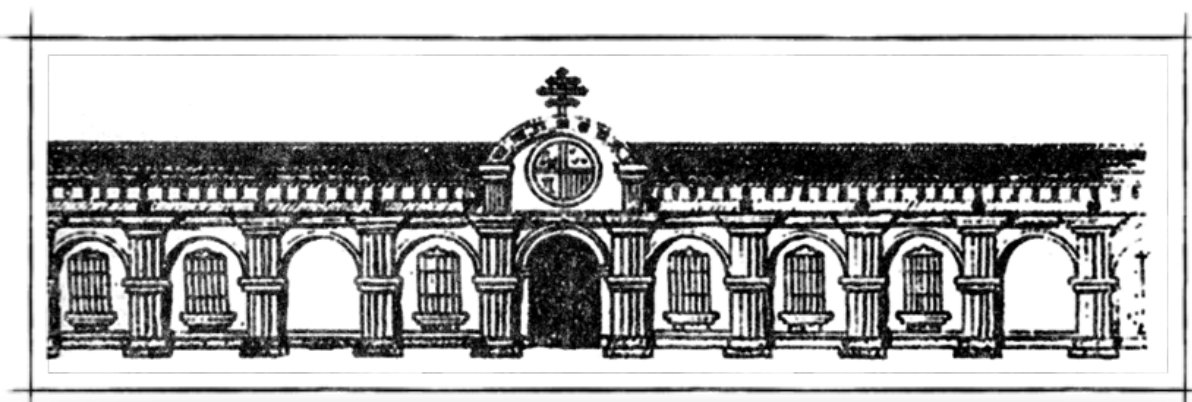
Fachada del edificio de las Cajas Reales en la Plaza Mayor de San Salvador hacia 1784<sup>13</sup>
